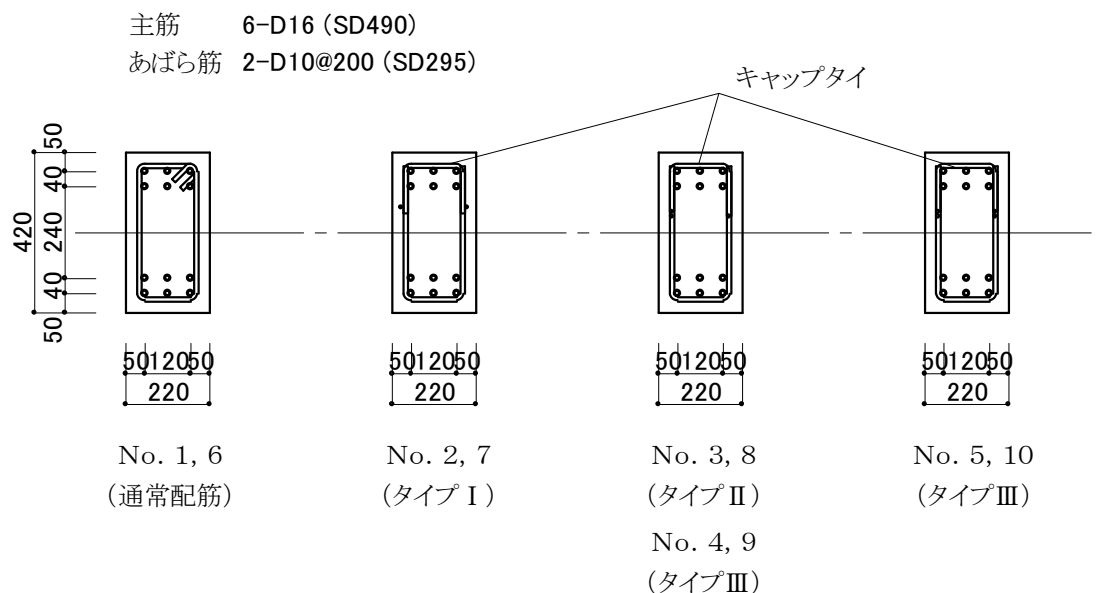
シリーズ 1 基礎梁実験の試験体の断面と配筋
